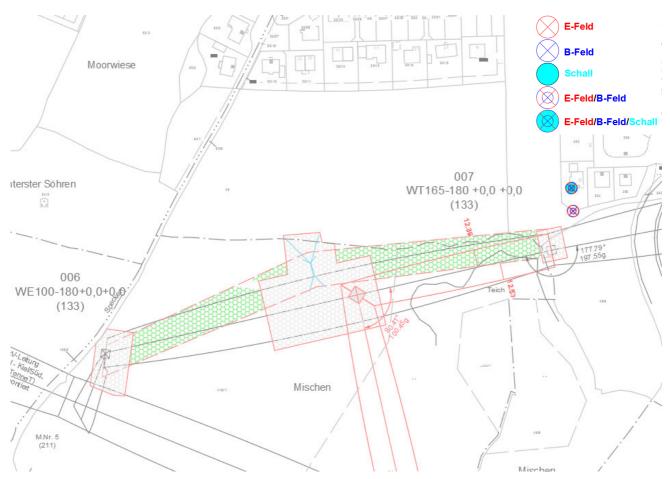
Lageplanausschnitt der Leitung LH-13-202 mit dem Berechnungspunkten
